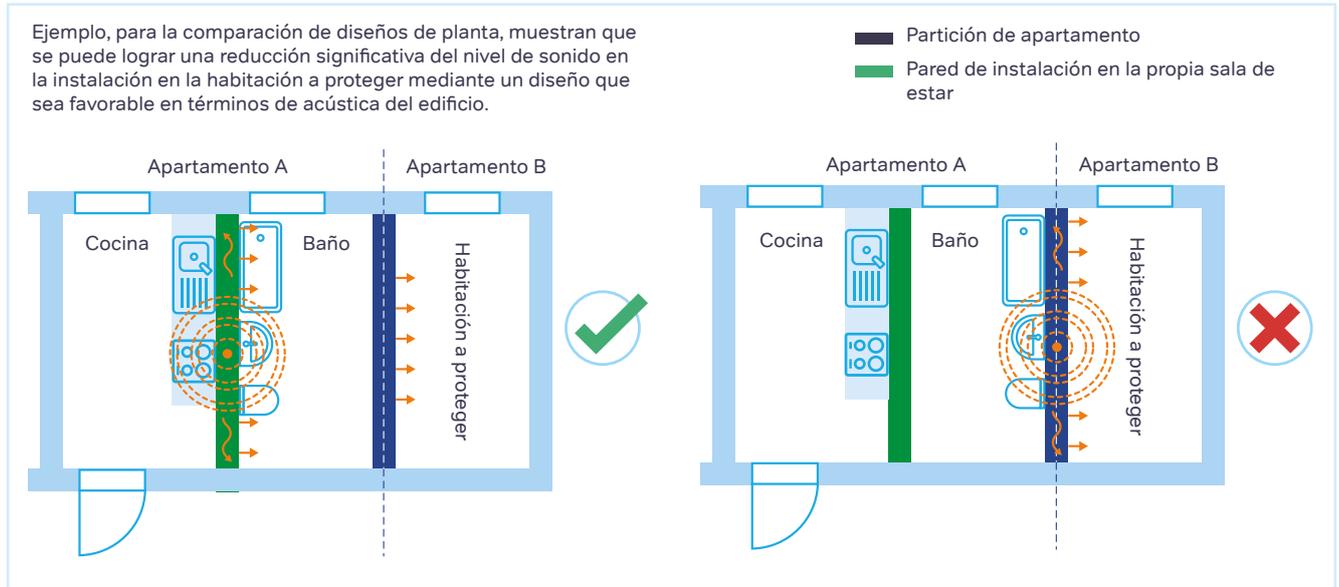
Una planta favorable desde el punto de vista de acústica del edificio.
